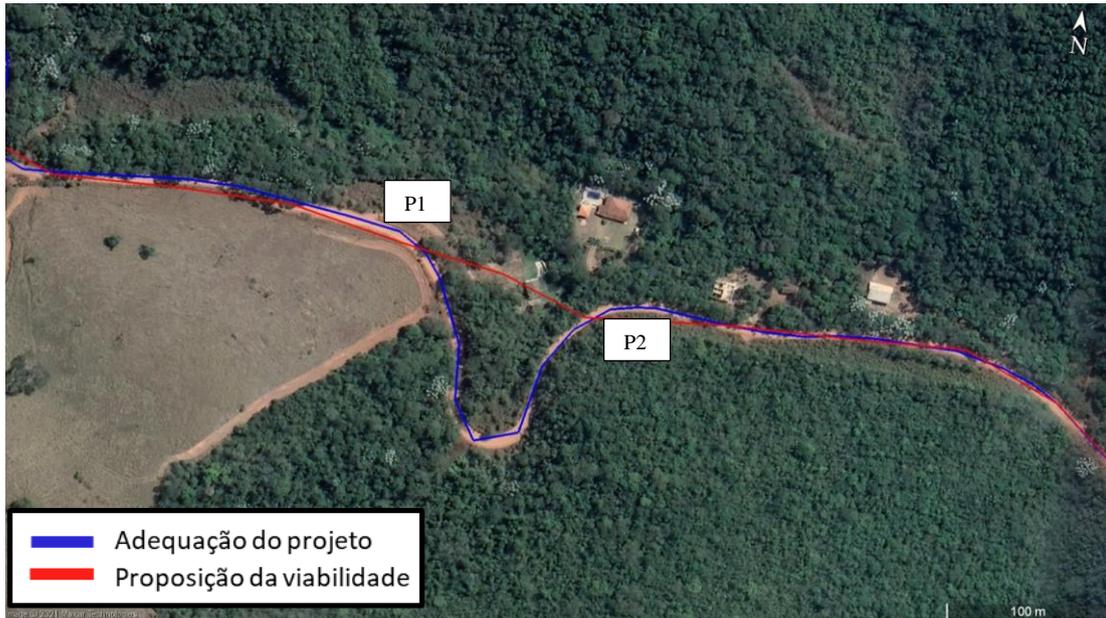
Adequação no Traçado da Adutora - Trecho em Estradas
